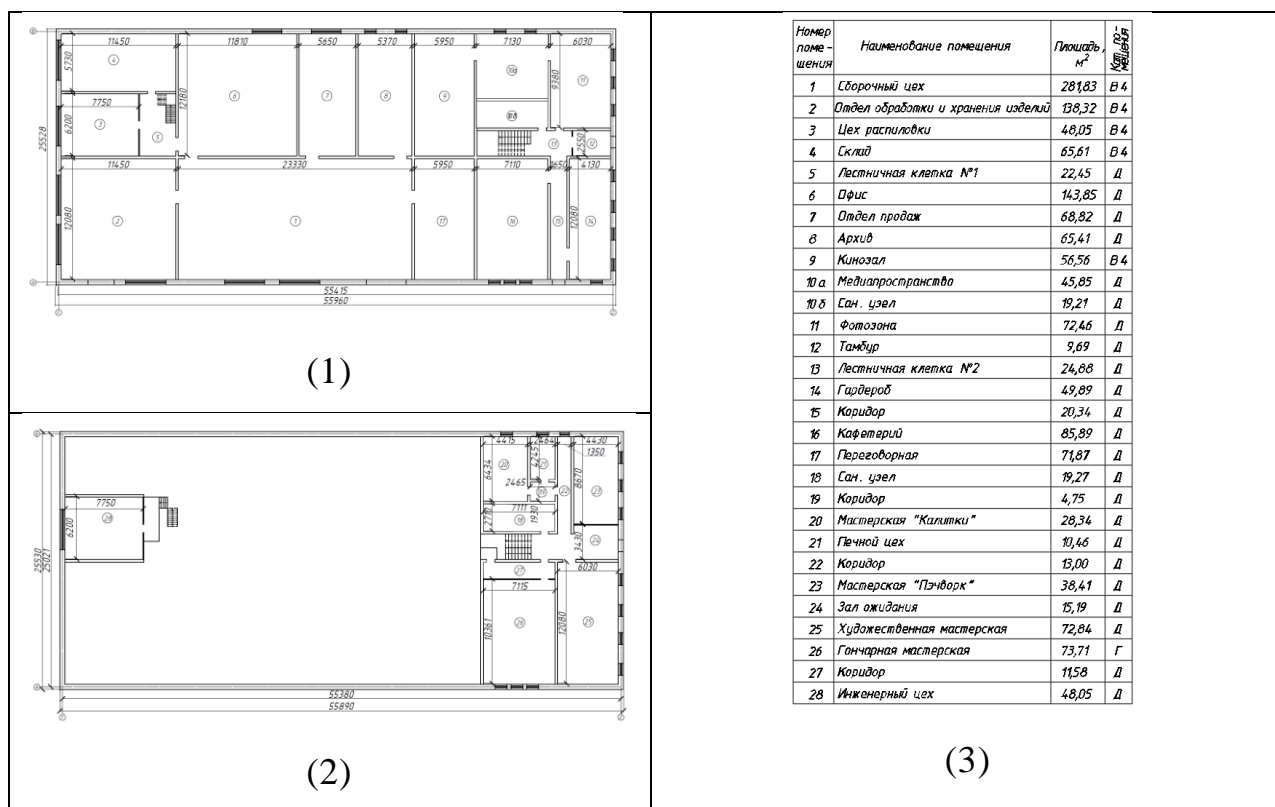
План здания после модернизации: план первого этажа (1); план второго этажа (2), экспликация помещений здания после перепланировки (3)
